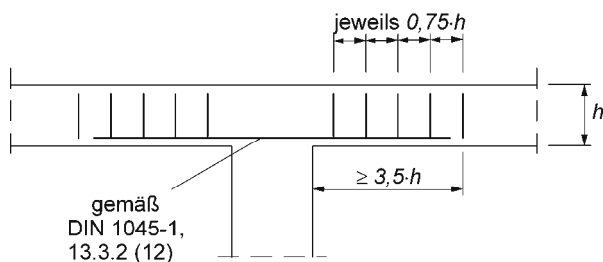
Konstruktive Durchbildung der Verbindung Stütze-Decke bei Flach- oder Pilzdecken
